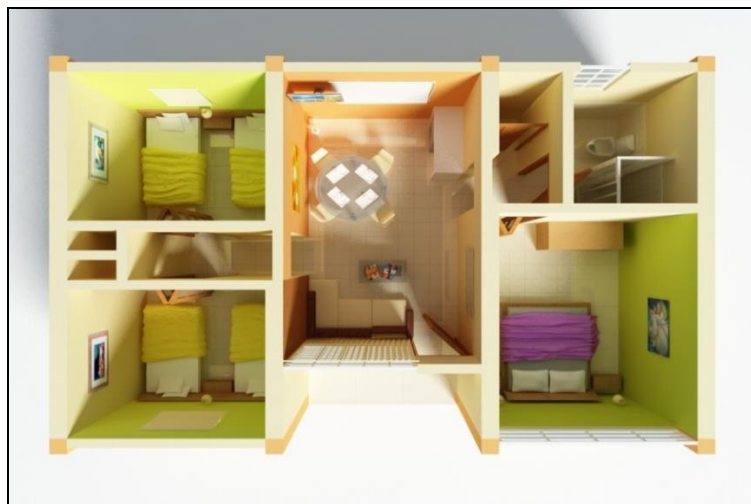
Vista de planta de propuesta de vivienda ecológica.
